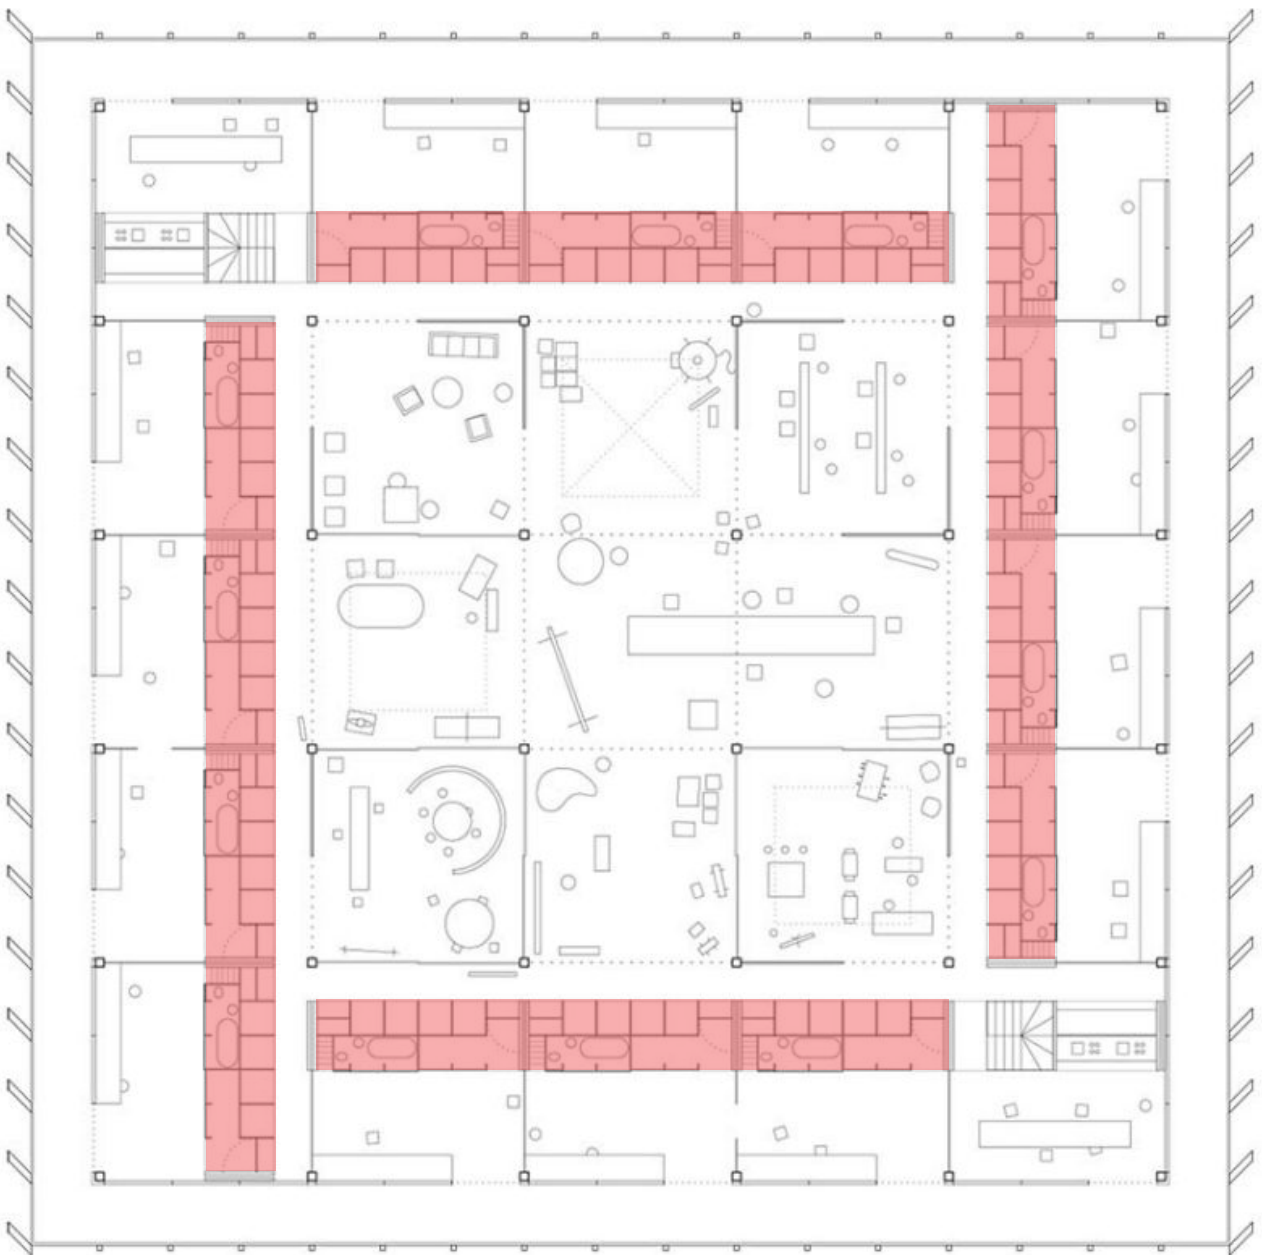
Grundriss Communal Villa - Villa Suburbana, Dogma, 2017, hiddenarchitecture.net
